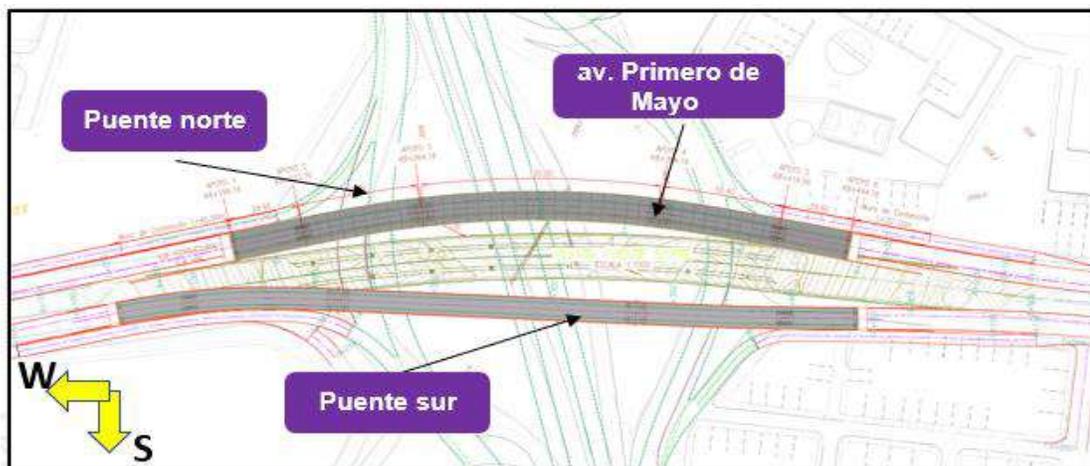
Planta general de la Intersección vial de Av. 68 con Av. 1ro de mayo
